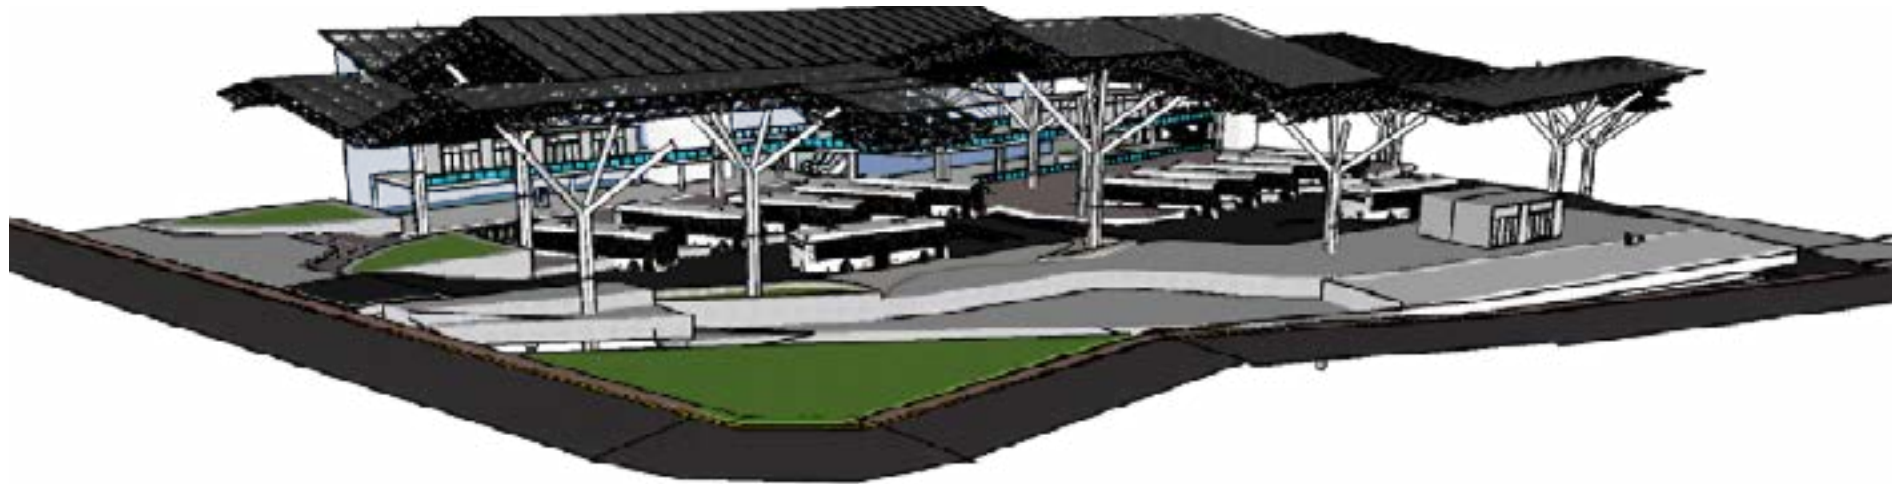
Sánchez, R. (2019). Vista externa de conjunto.
